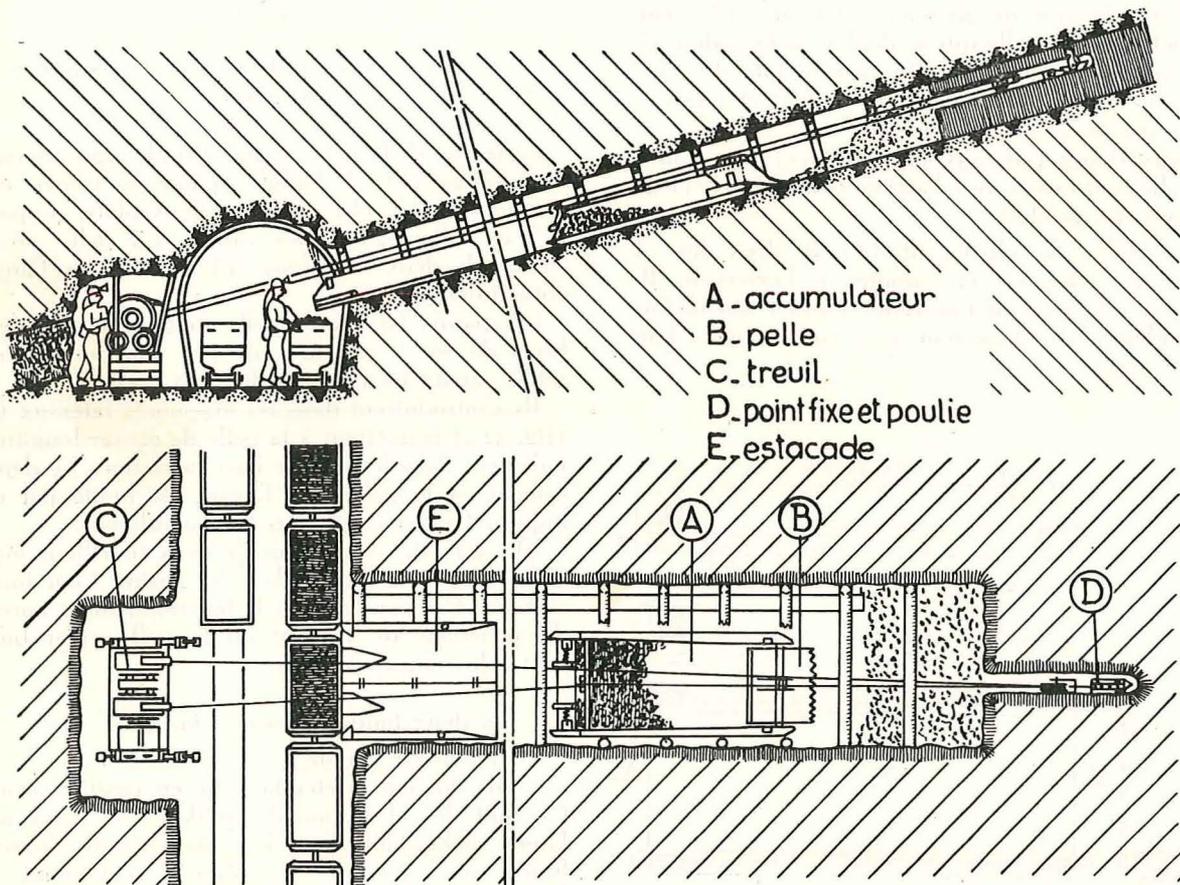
Coupe et vue en plan d'une installation de scraper - accumulateur.
